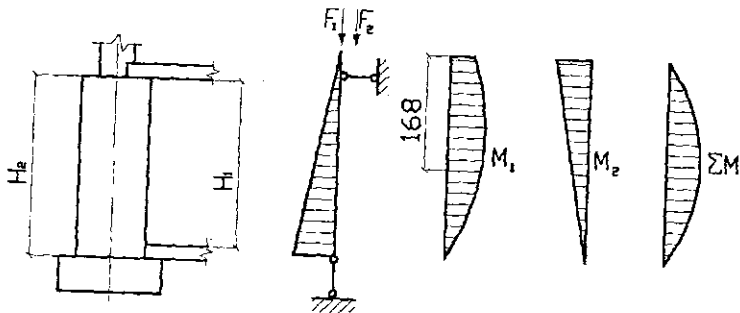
Расчетная схема стены подвала и эпюра моментов
